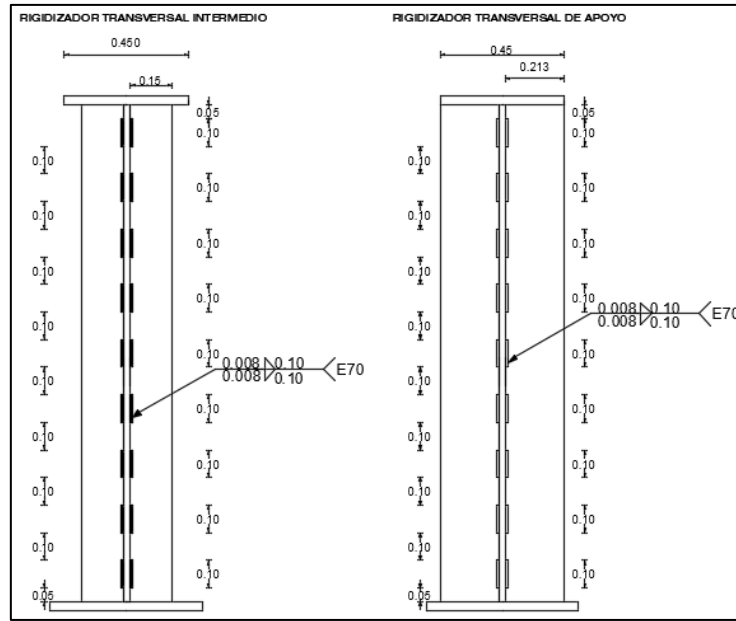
Soldadura de filete entre el alma de la viga y el rigidizador transversal.
